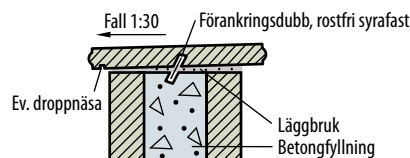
Avtäckning på dubbelsidig beklädnadsmur.
